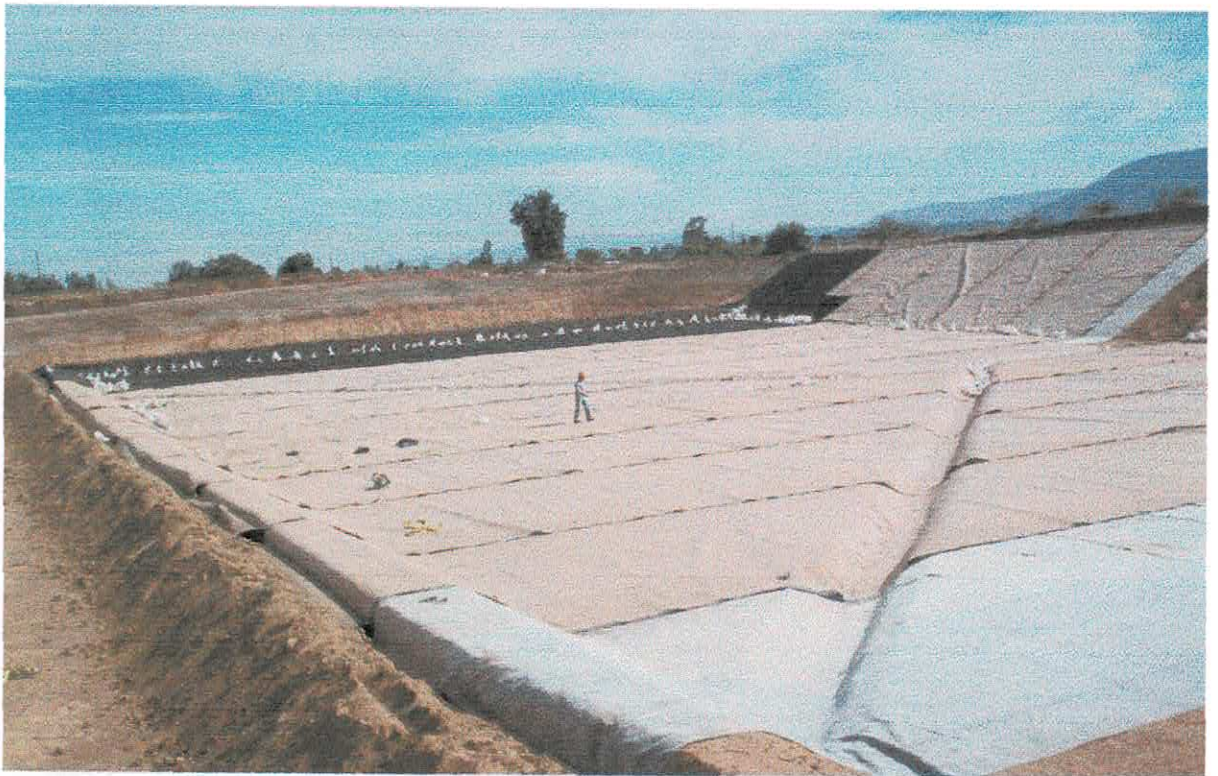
Impermeabilización Basal del Primer Sector de Disposición (18.04.2005)
